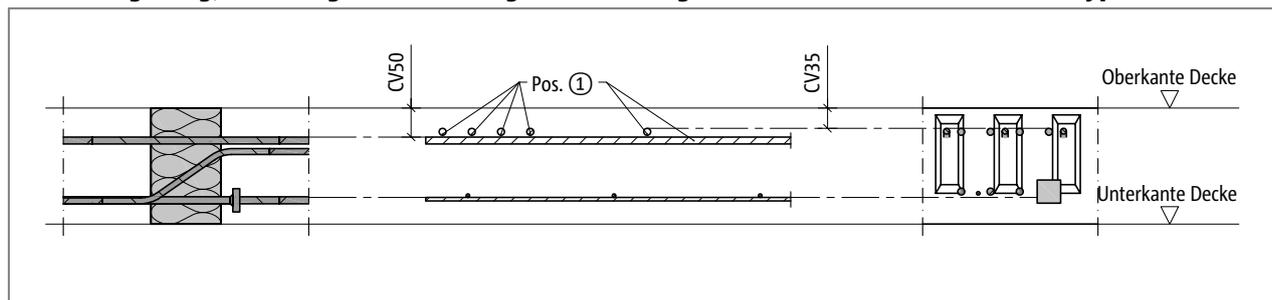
Schöck Isokorb® Typ EXT: Bauseitige Bewehrung Außenecke (Schnitt EXT-L-CV50, Ansicht EXT-R-CV35)
